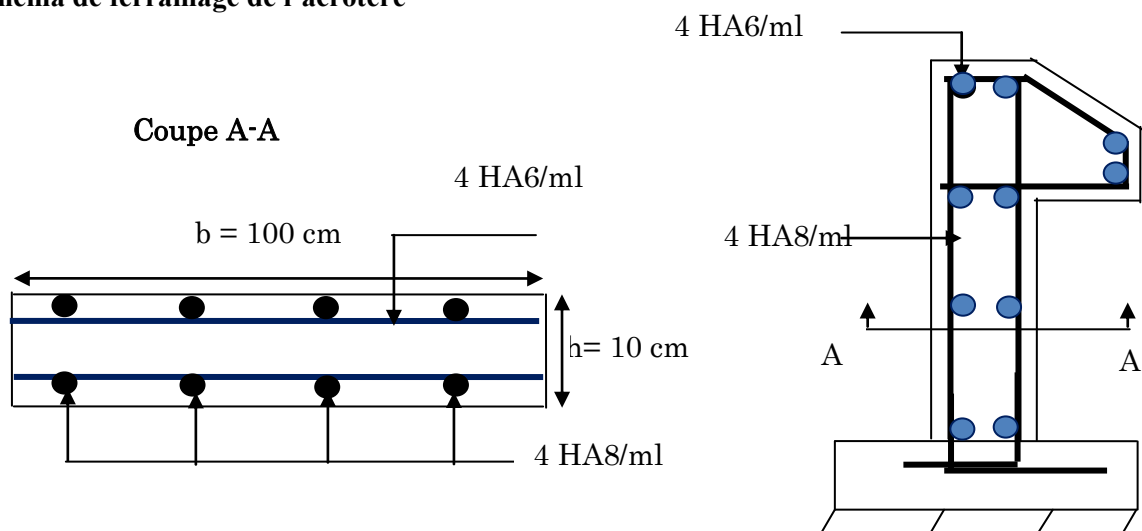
Schéma de ferrailage de l'acrotère.
